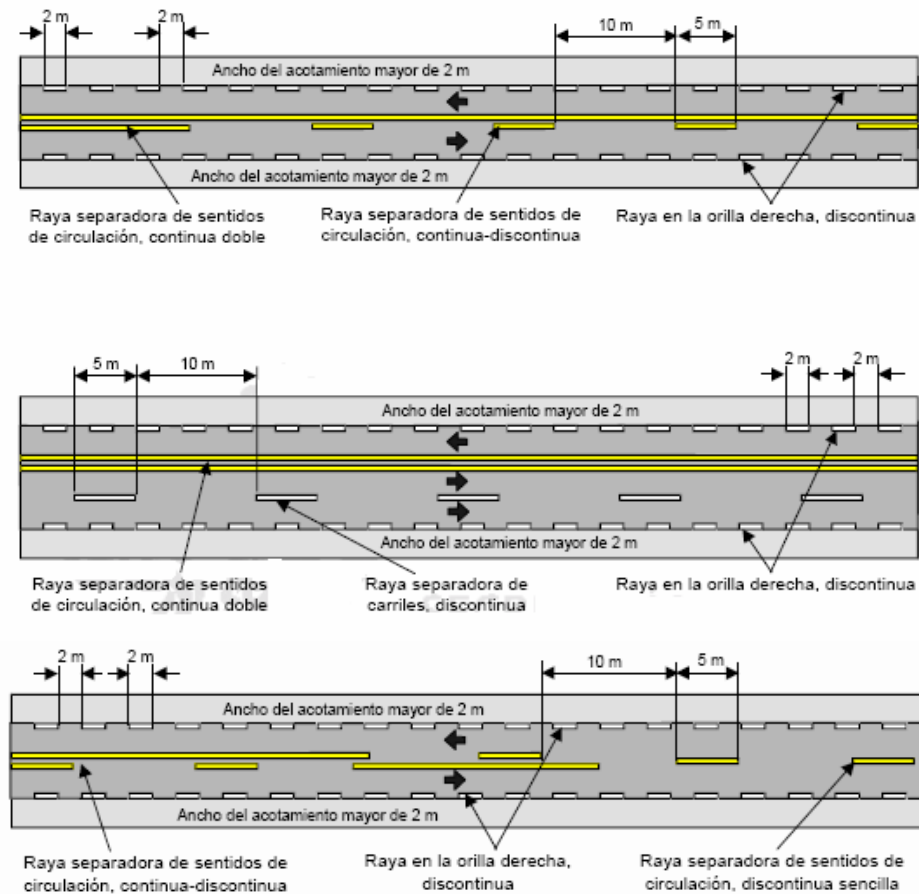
Marcas en el pavimento en carreteras con ancho de calzada mayor de 6.5m.
